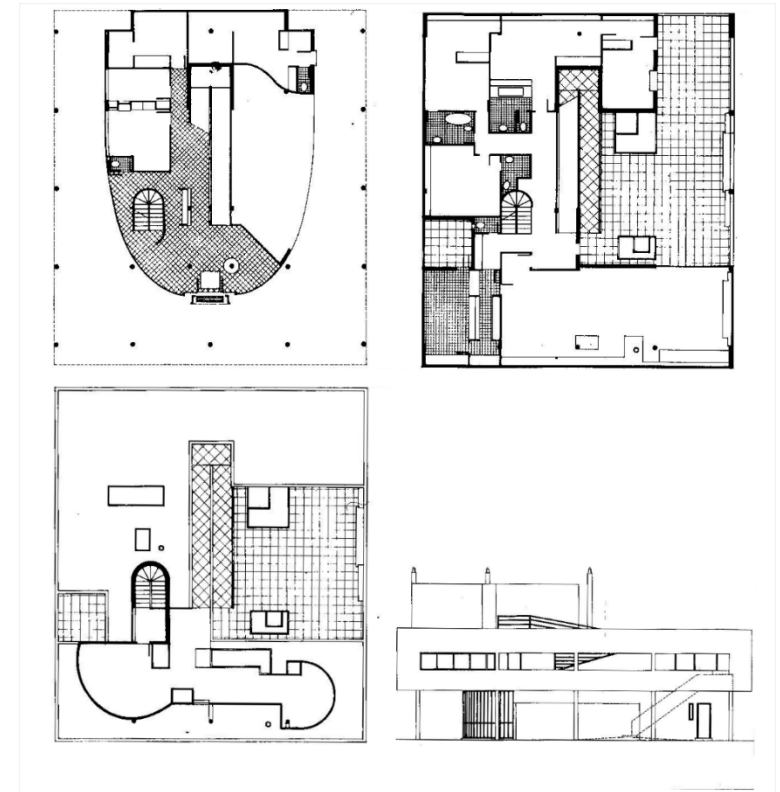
Vila Savoye, quarta proposta. Plantas do térreo, primeiro e segundo pavimento e fachada lateral respectivamente, 17 de dezembro de 1928. Fonte: Benton, 1984 pg. 198.
